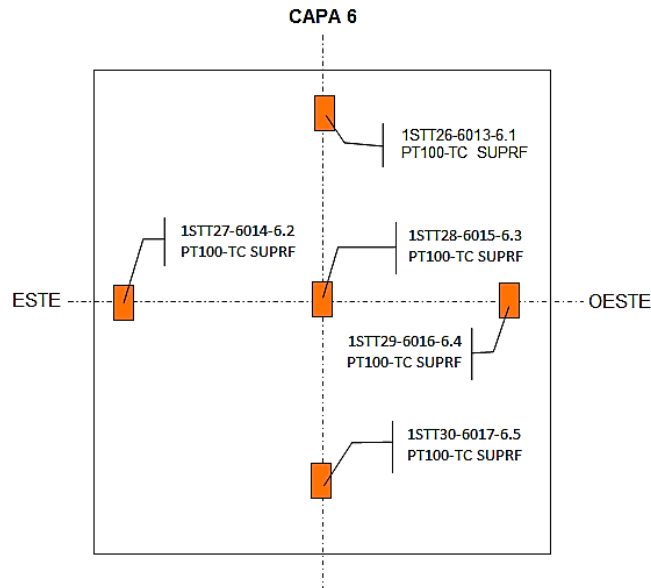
Instrumentación añadida al muro base con aislamiento
